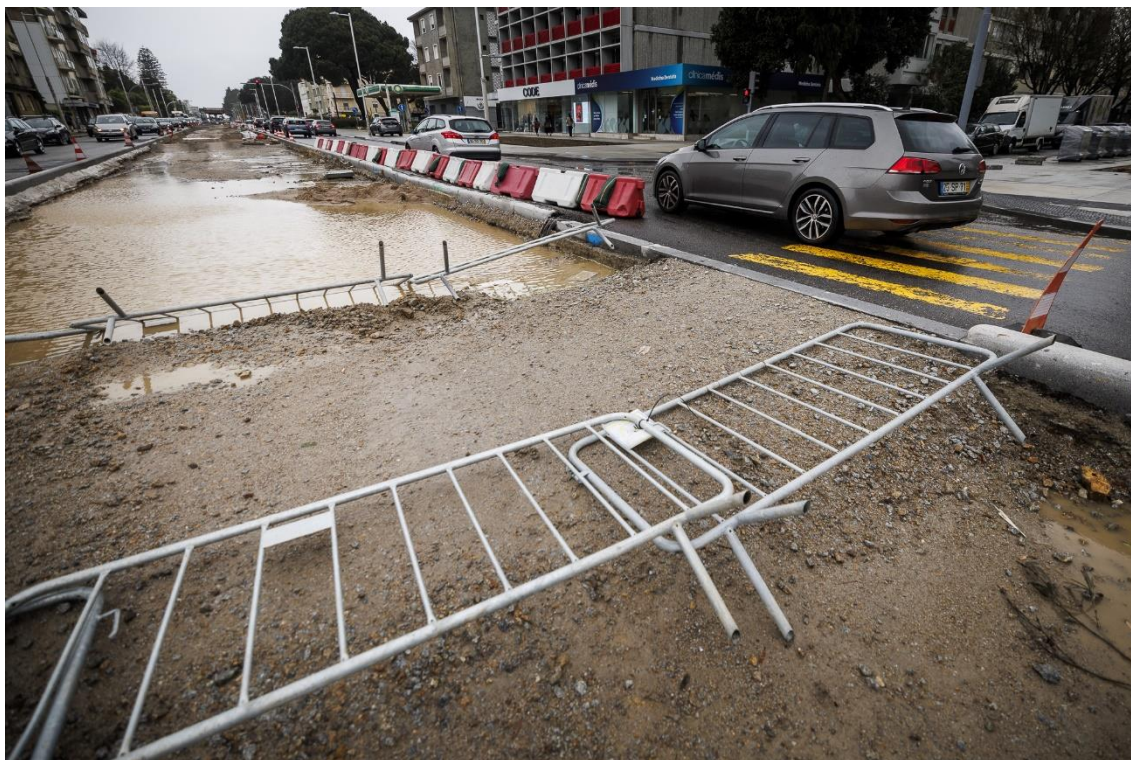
Passadeira provisória na Avenida da Boavista (28 março 2024).
